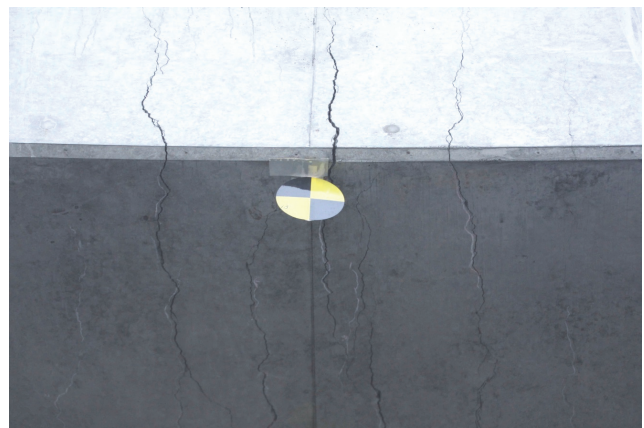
頂版のひび割れ状況 (G-CC-E3,000)
